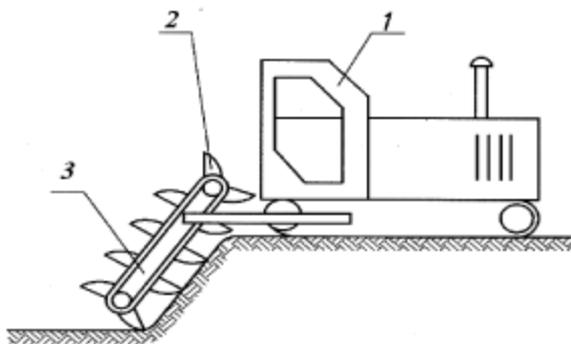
Многоковшовый экскаватор с ковшовой цепью:
